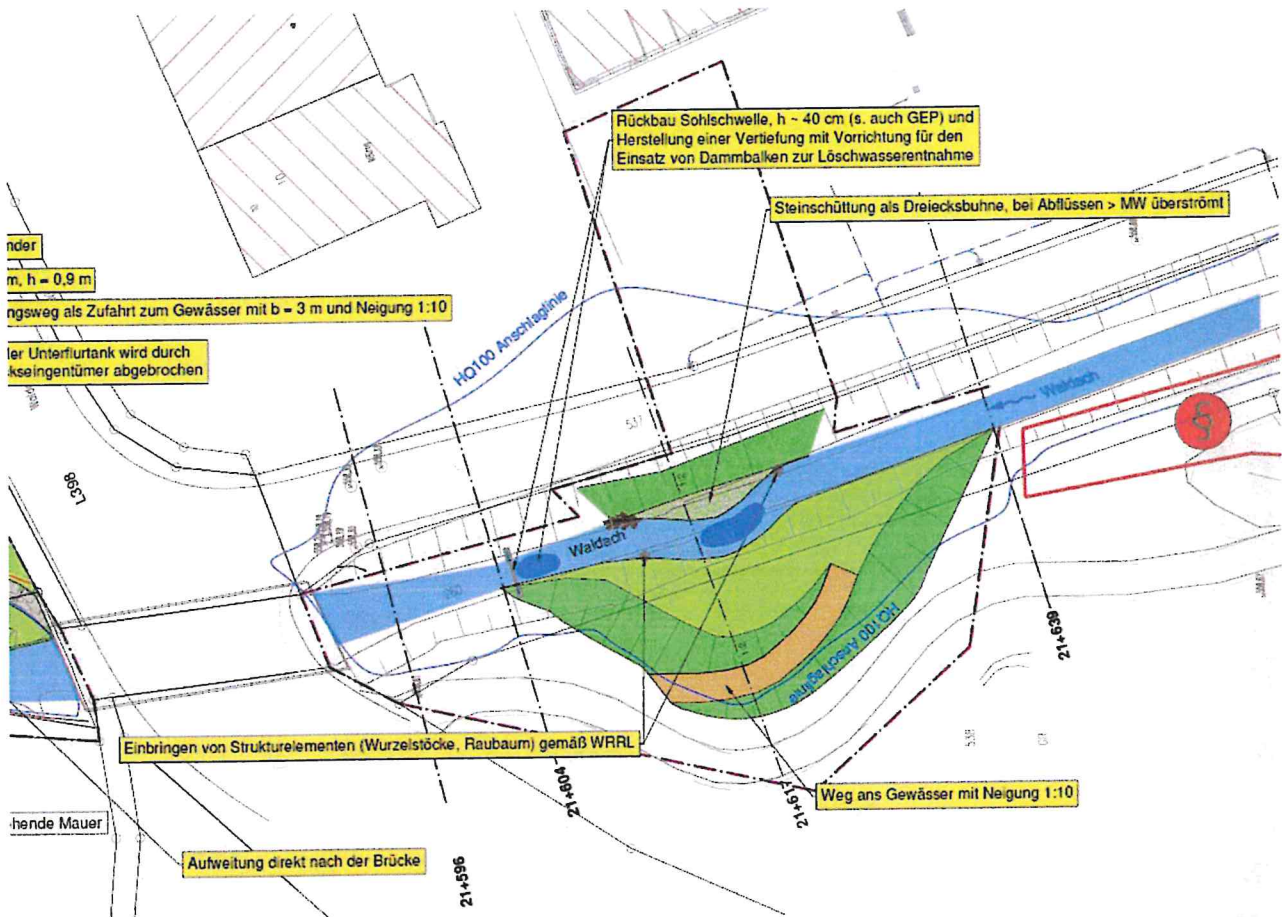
Ausschnitt aus dem Lageplan der Renaturierung, Büro Wald & Corbe, Fassung vom 19.07.2019
